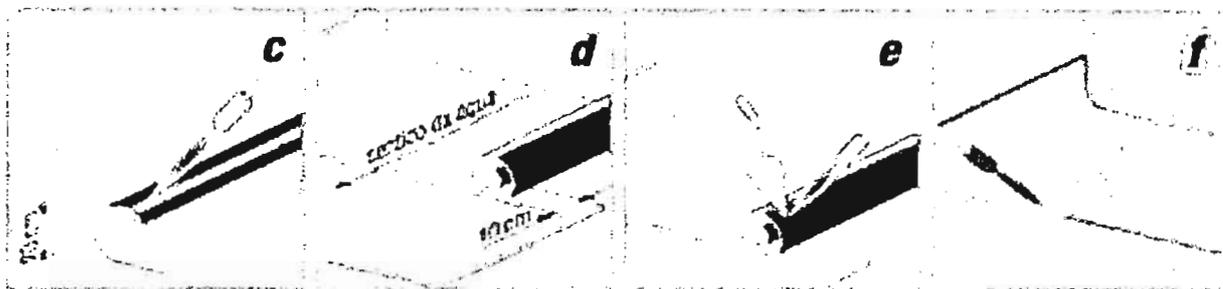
Desenho esquemático de aplicação da manta asfáltica.
